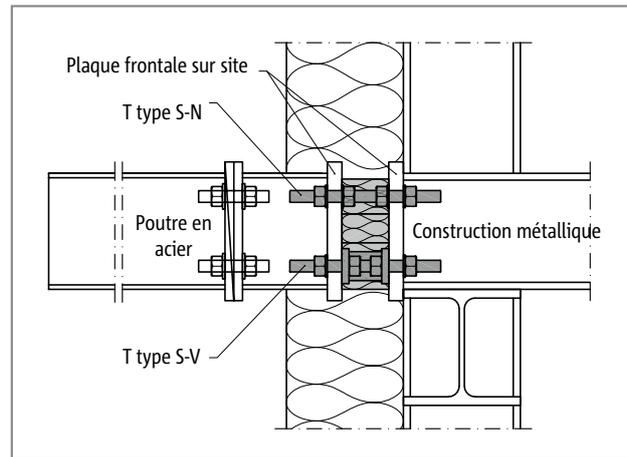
Schöck Isokorb® T type S-N et T type S-V : construction en acier en porte-à-faux libre ; adaptateur sur site
